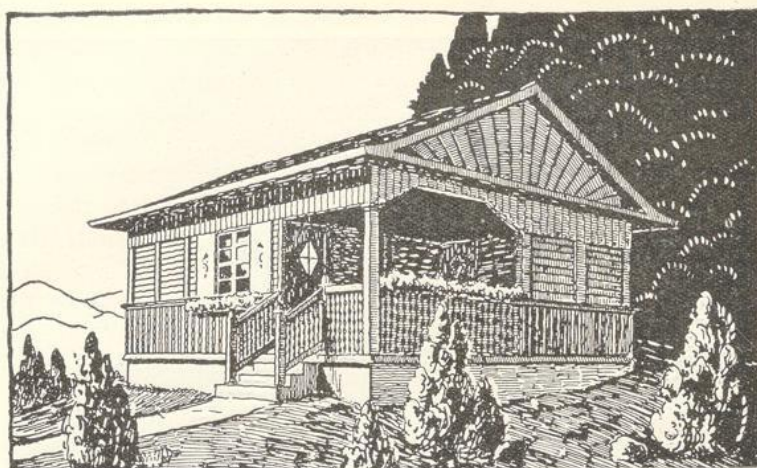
Wochenendhaus. Entwurf und Ausführung: Architekt und Zimmermeister B. d. Z. Friedr. W. Lohmüller, Güsten.
